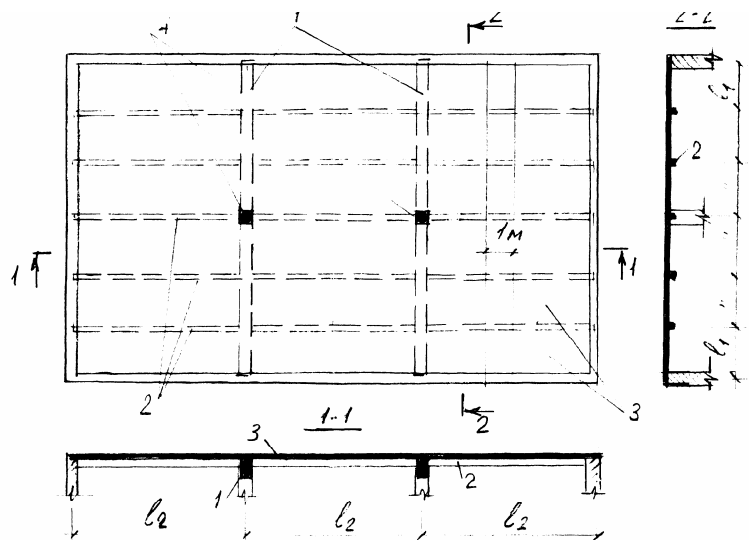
Монолітне ребристе переkritтя з балковими плитами:
